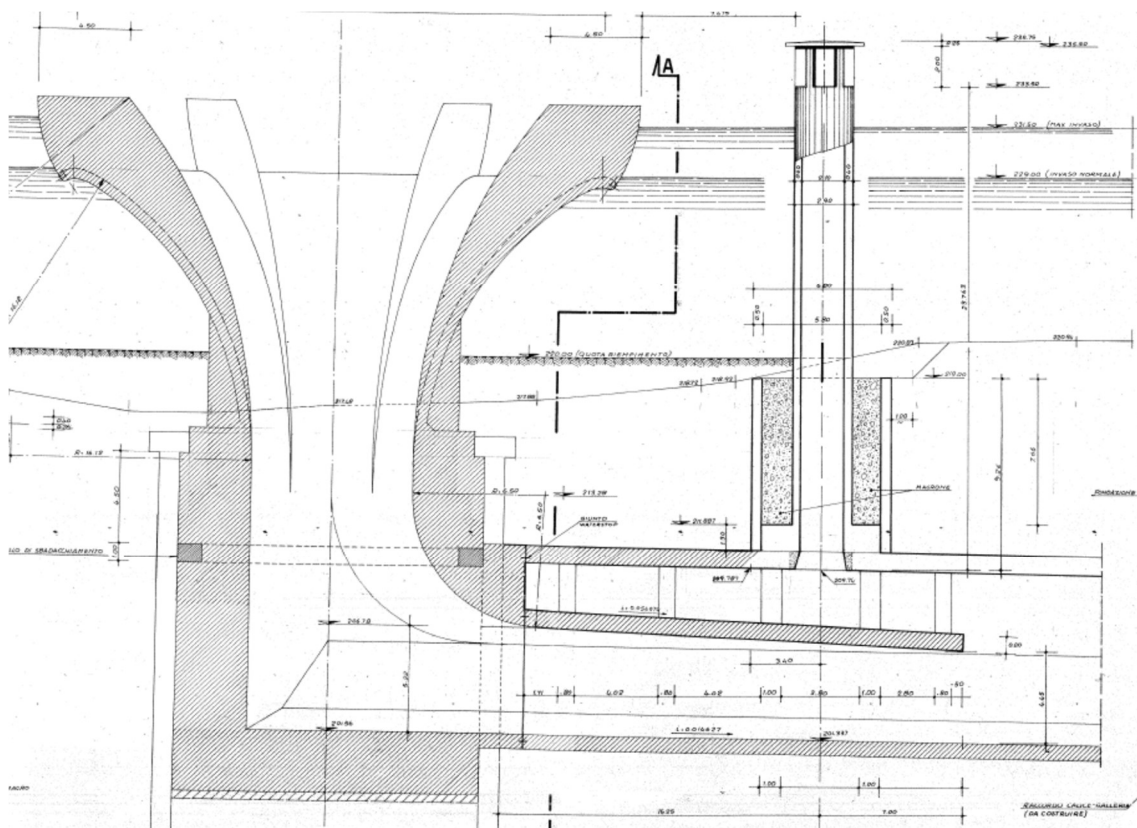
Sfioratore a calice sinistro – Sezione longitudinale
